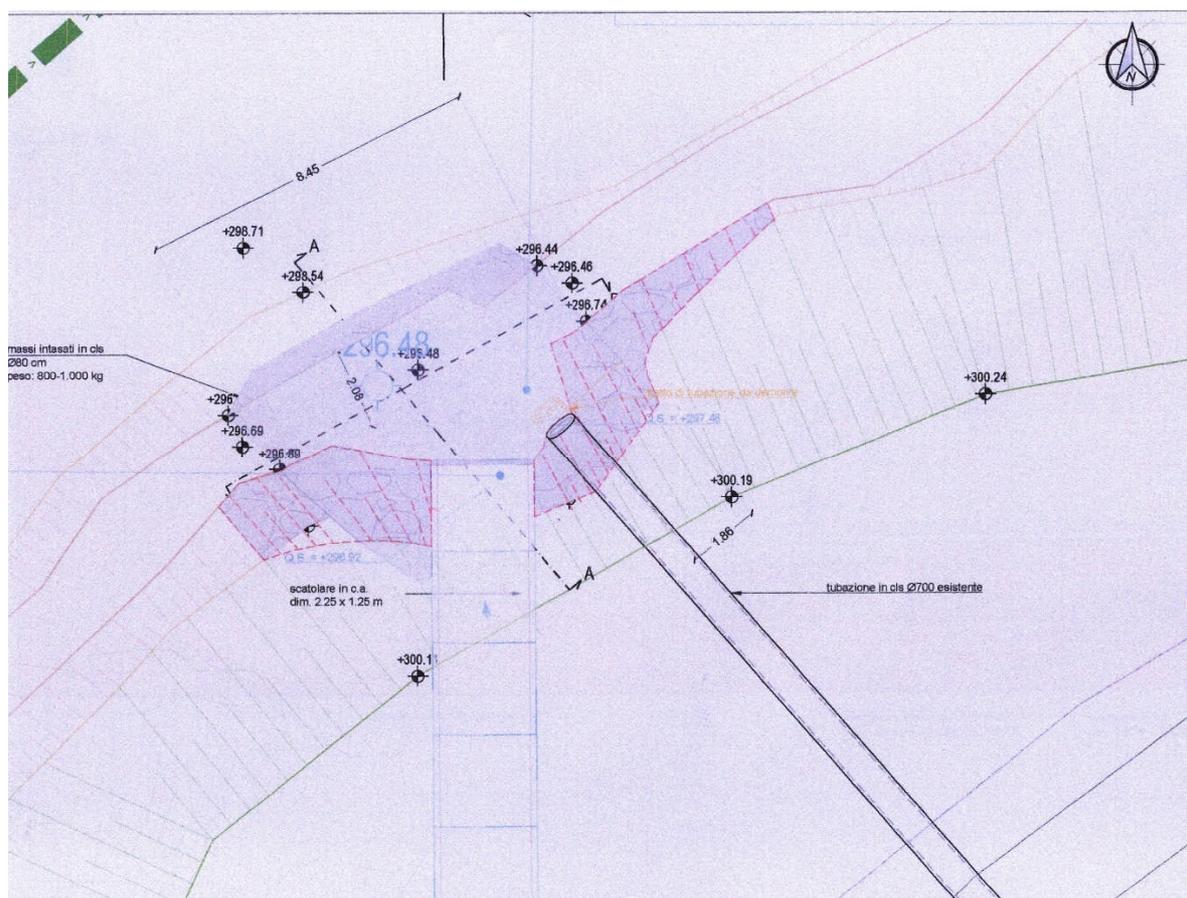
Progetto Rev. 09/2023 - Estratto planimetria manufatto di sbocco
